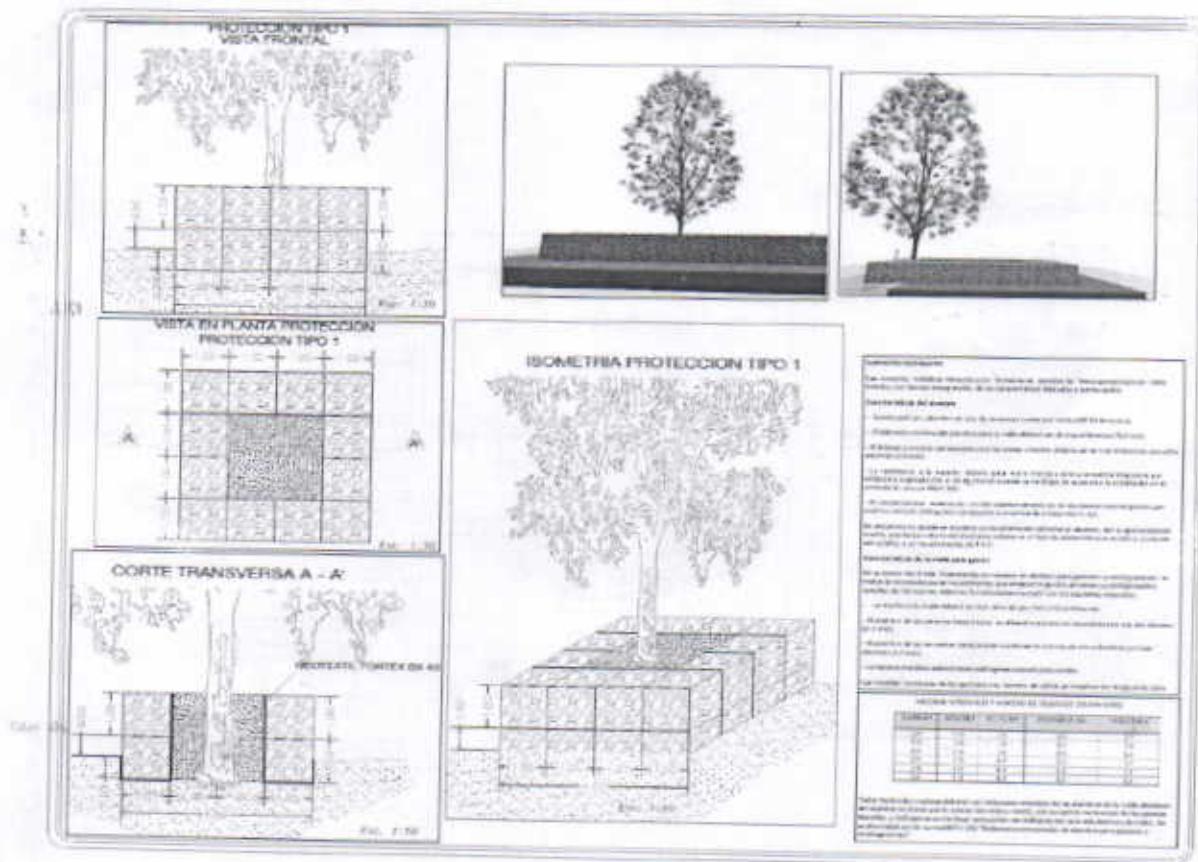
Imagen Tipo, Planos Planta, perfil e isométrico General de solución de protección TIPO No 1
